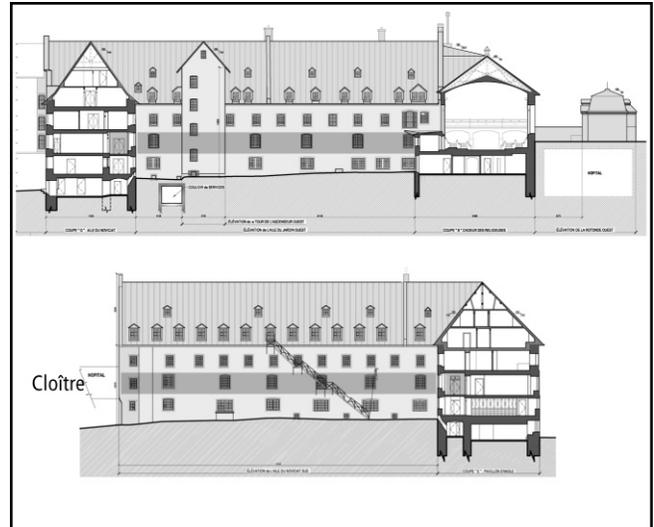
Élévation et coupe du cloître sur la cour intérieur
